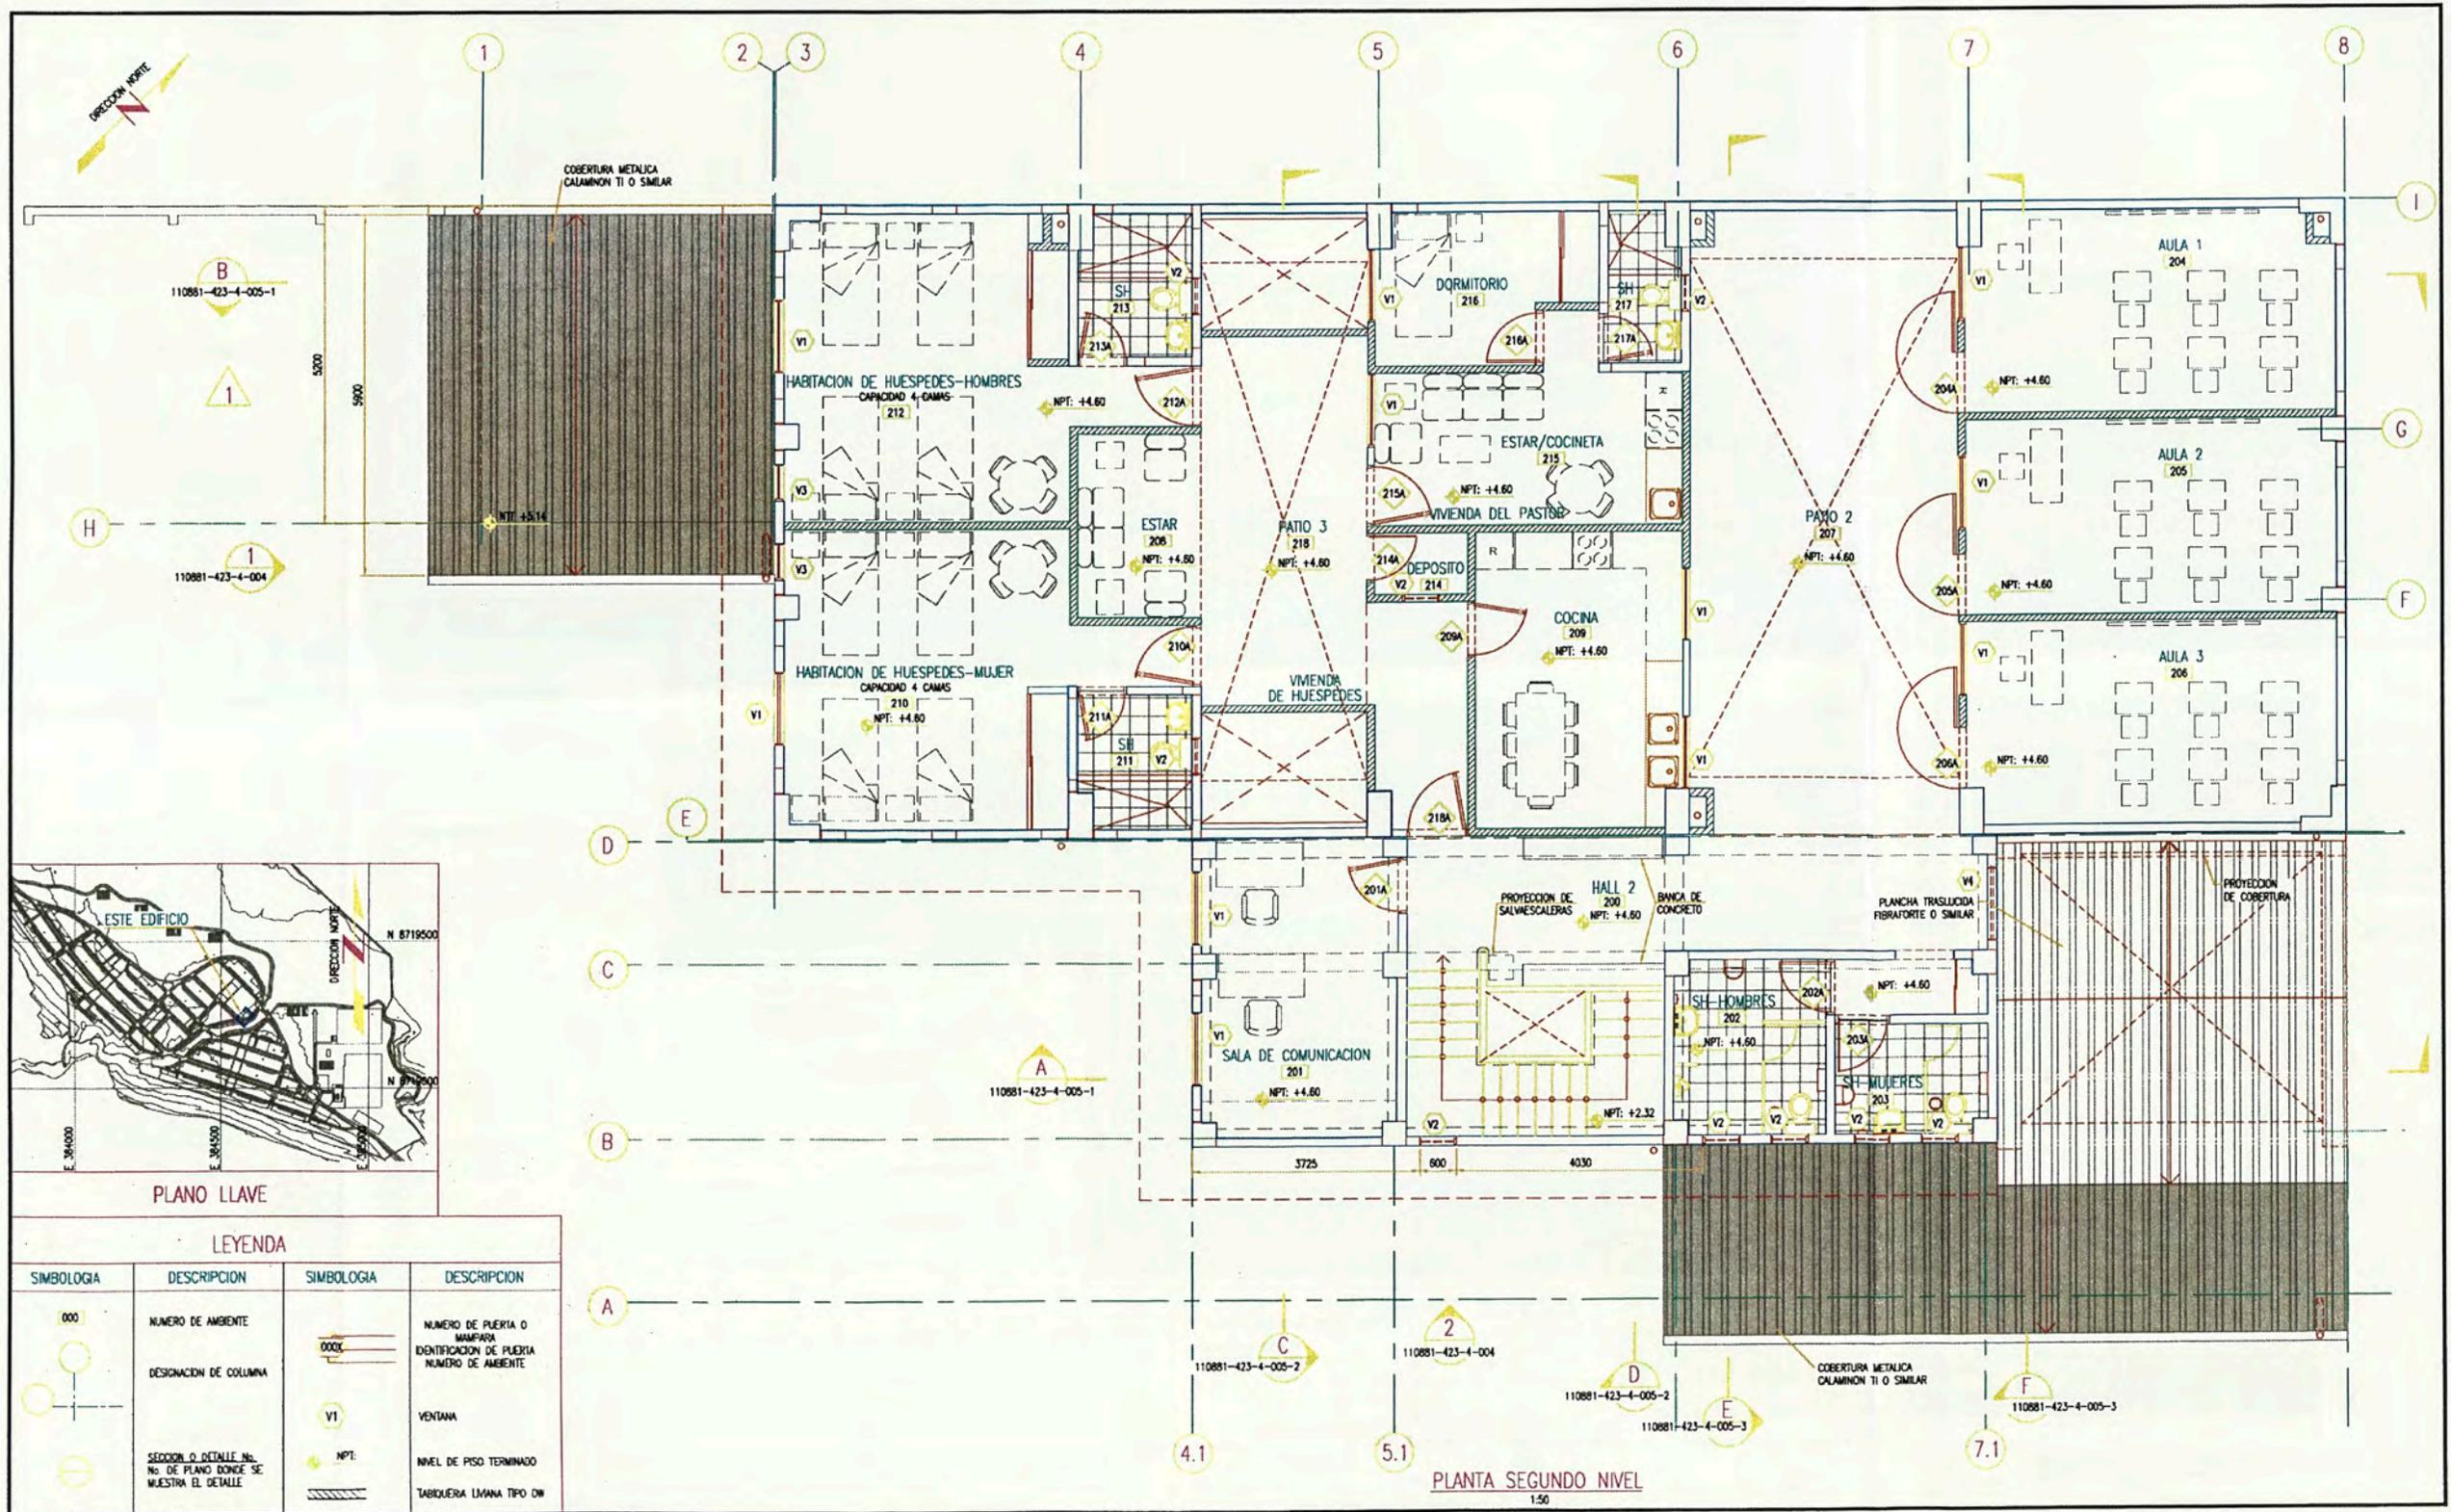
Plano de Arquitectura, planta segundo nivel
